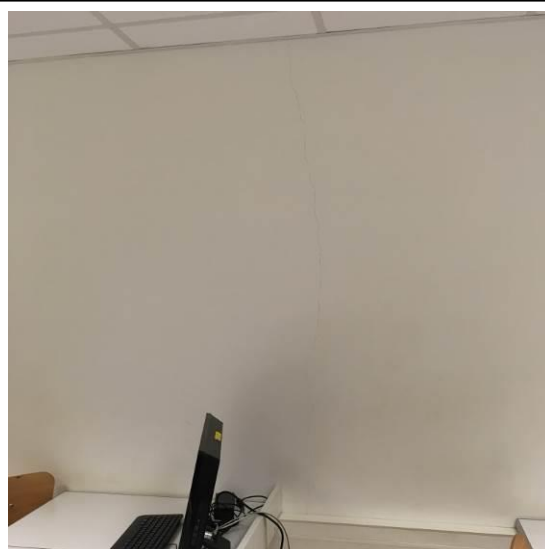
Bâtiment B RDC, local entretien - Paroi verticale : D2 – Fissuration modérée.
